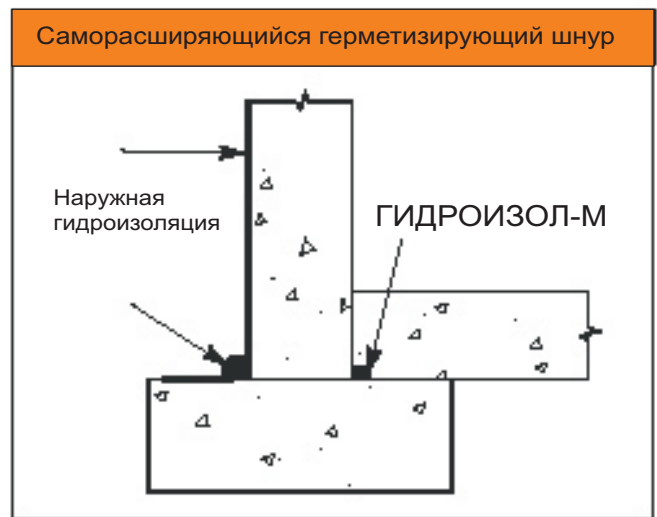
Монтаж шнура без нижней гориз. гидроизоляции свайного оголовка и плиты.
